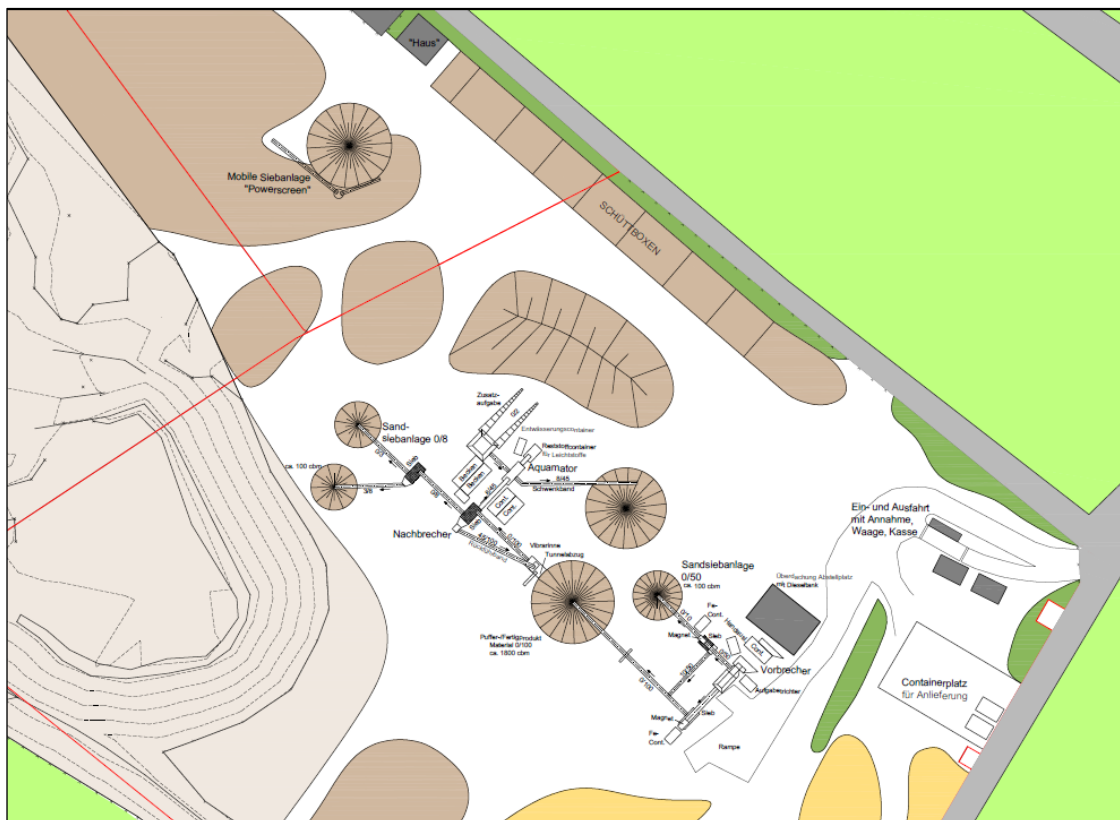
Anlagenanordnung innerhalb der Bauschuttrecyclinganlage. Aus: Antragsunterlagen „Baustoff-Recycling Speyer, Änderung von Anlage und Betrieb gem. § 16 BImSchG“ erstellt durch Ehrenberg Landschaftsarchitekten, Kaiserslautern, 01.04.2014
